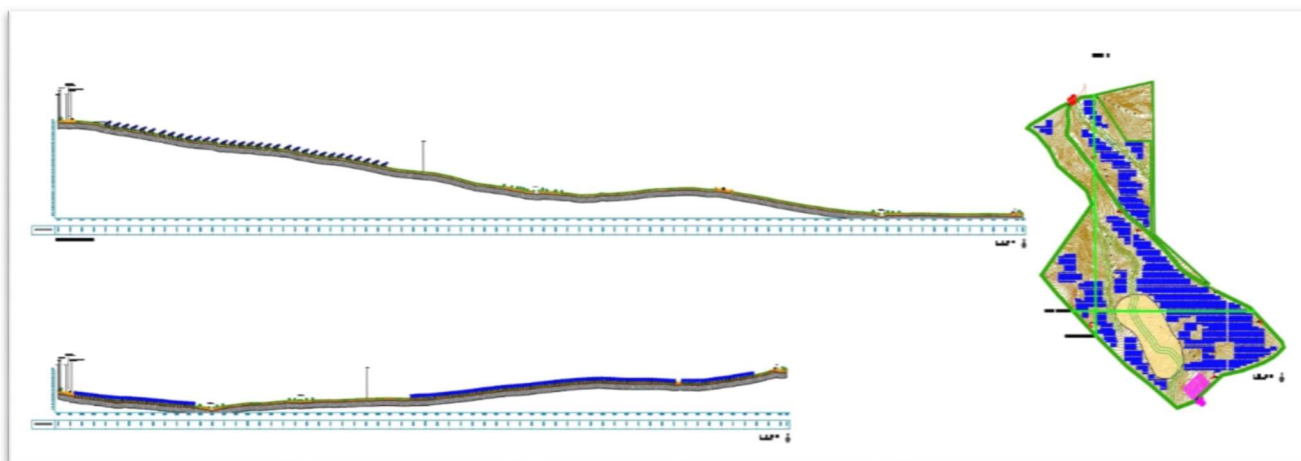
Area 3 Profili longitudinale e trasversale di progetto
